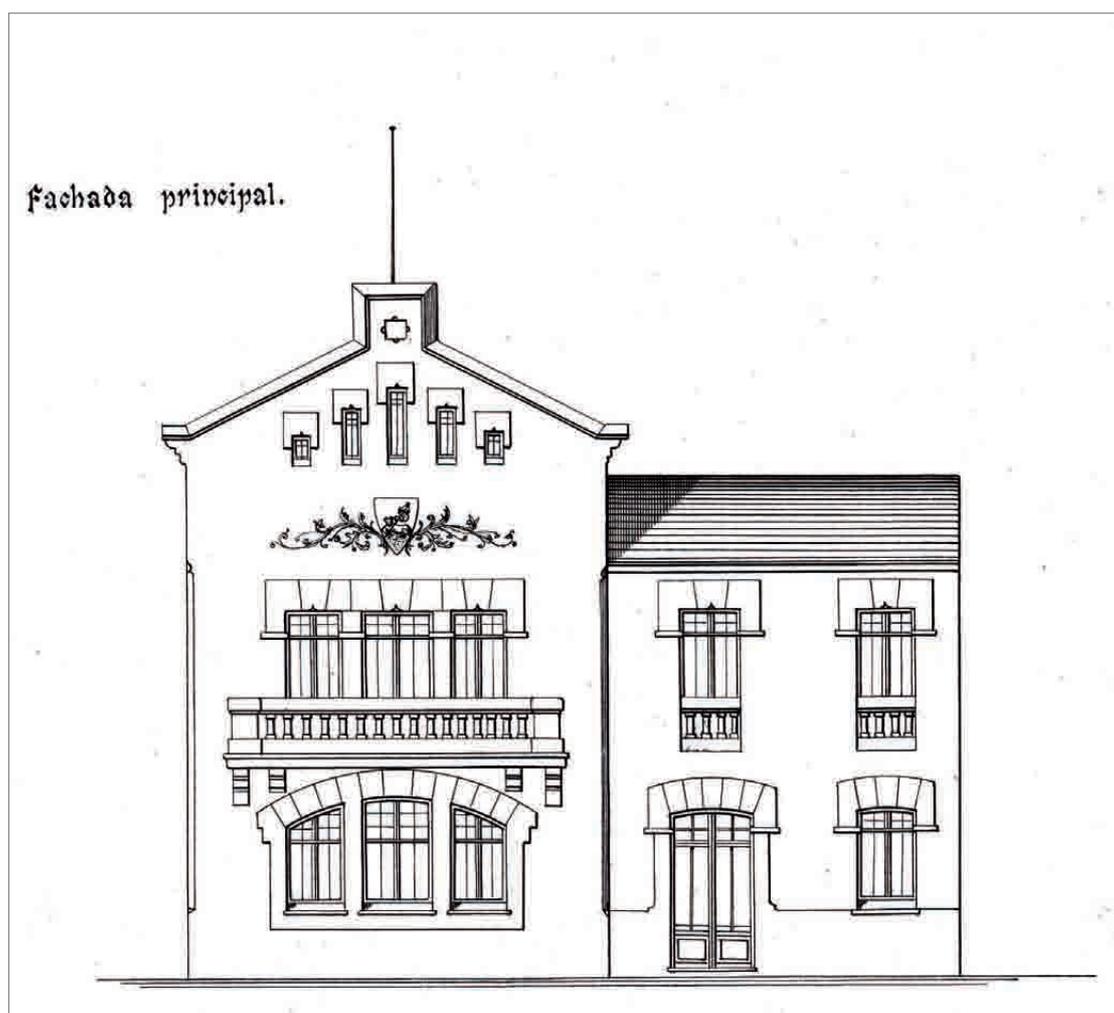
Alzado de la fachada de estilo modernista proyectada por Guillermo Reynés Font para el Ayuntamiento de Calvià.
